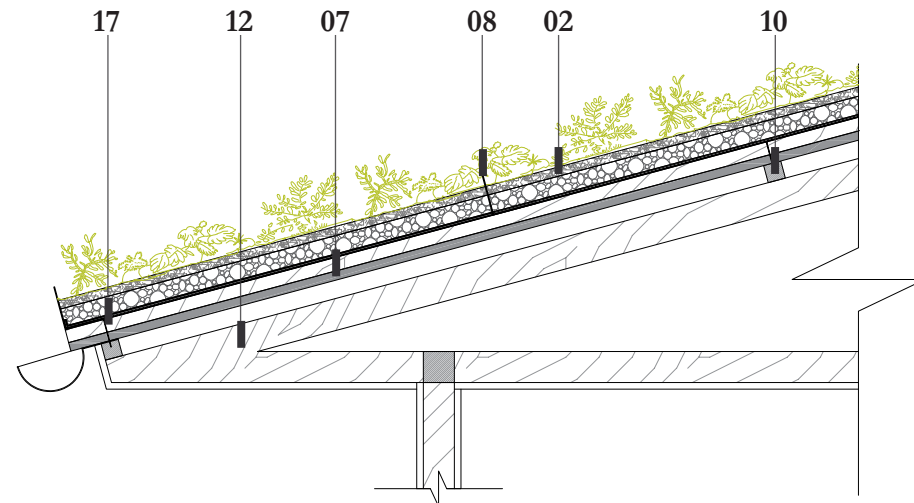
Detalle longitudinal de cubierta, Capas (Guzmán & Zuña, 2018)
